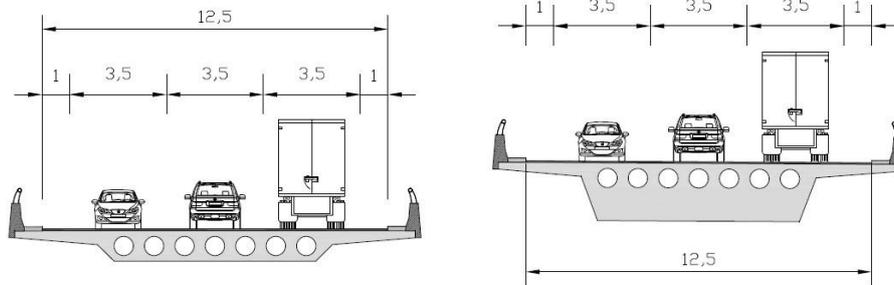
SECCIÓN TIPO DEL PUENTE 1. IZQDA EXTREMO DE VANO, DCHA CENTRO DE VANO (COTAS EN METROS)
